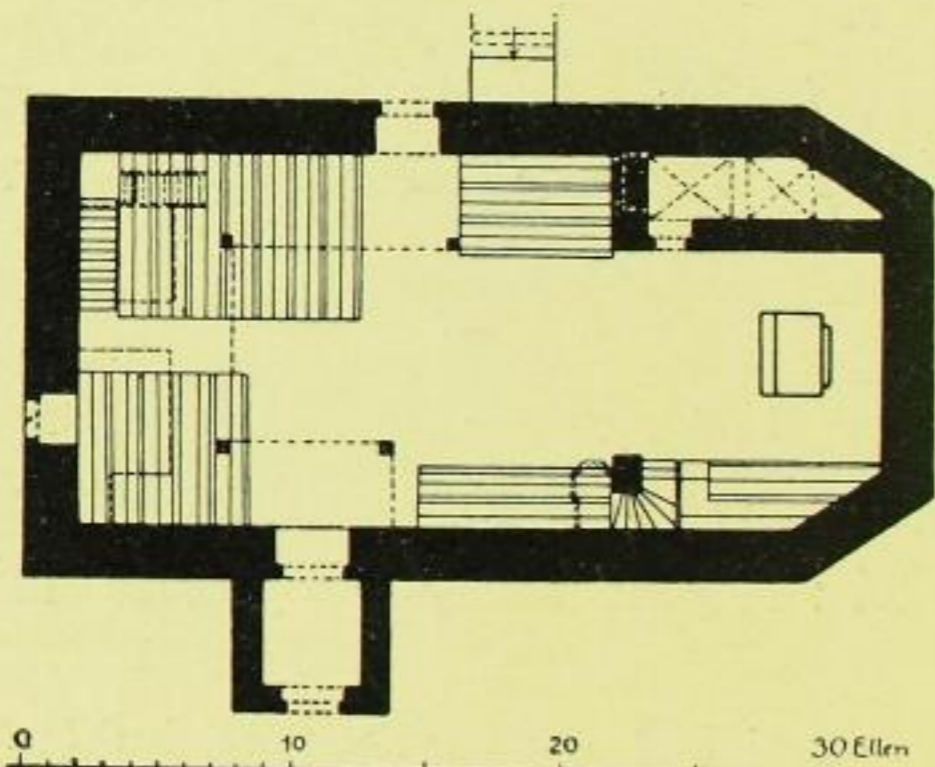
Linz, Kirche, Grundriß, Zustand vor 1859.
